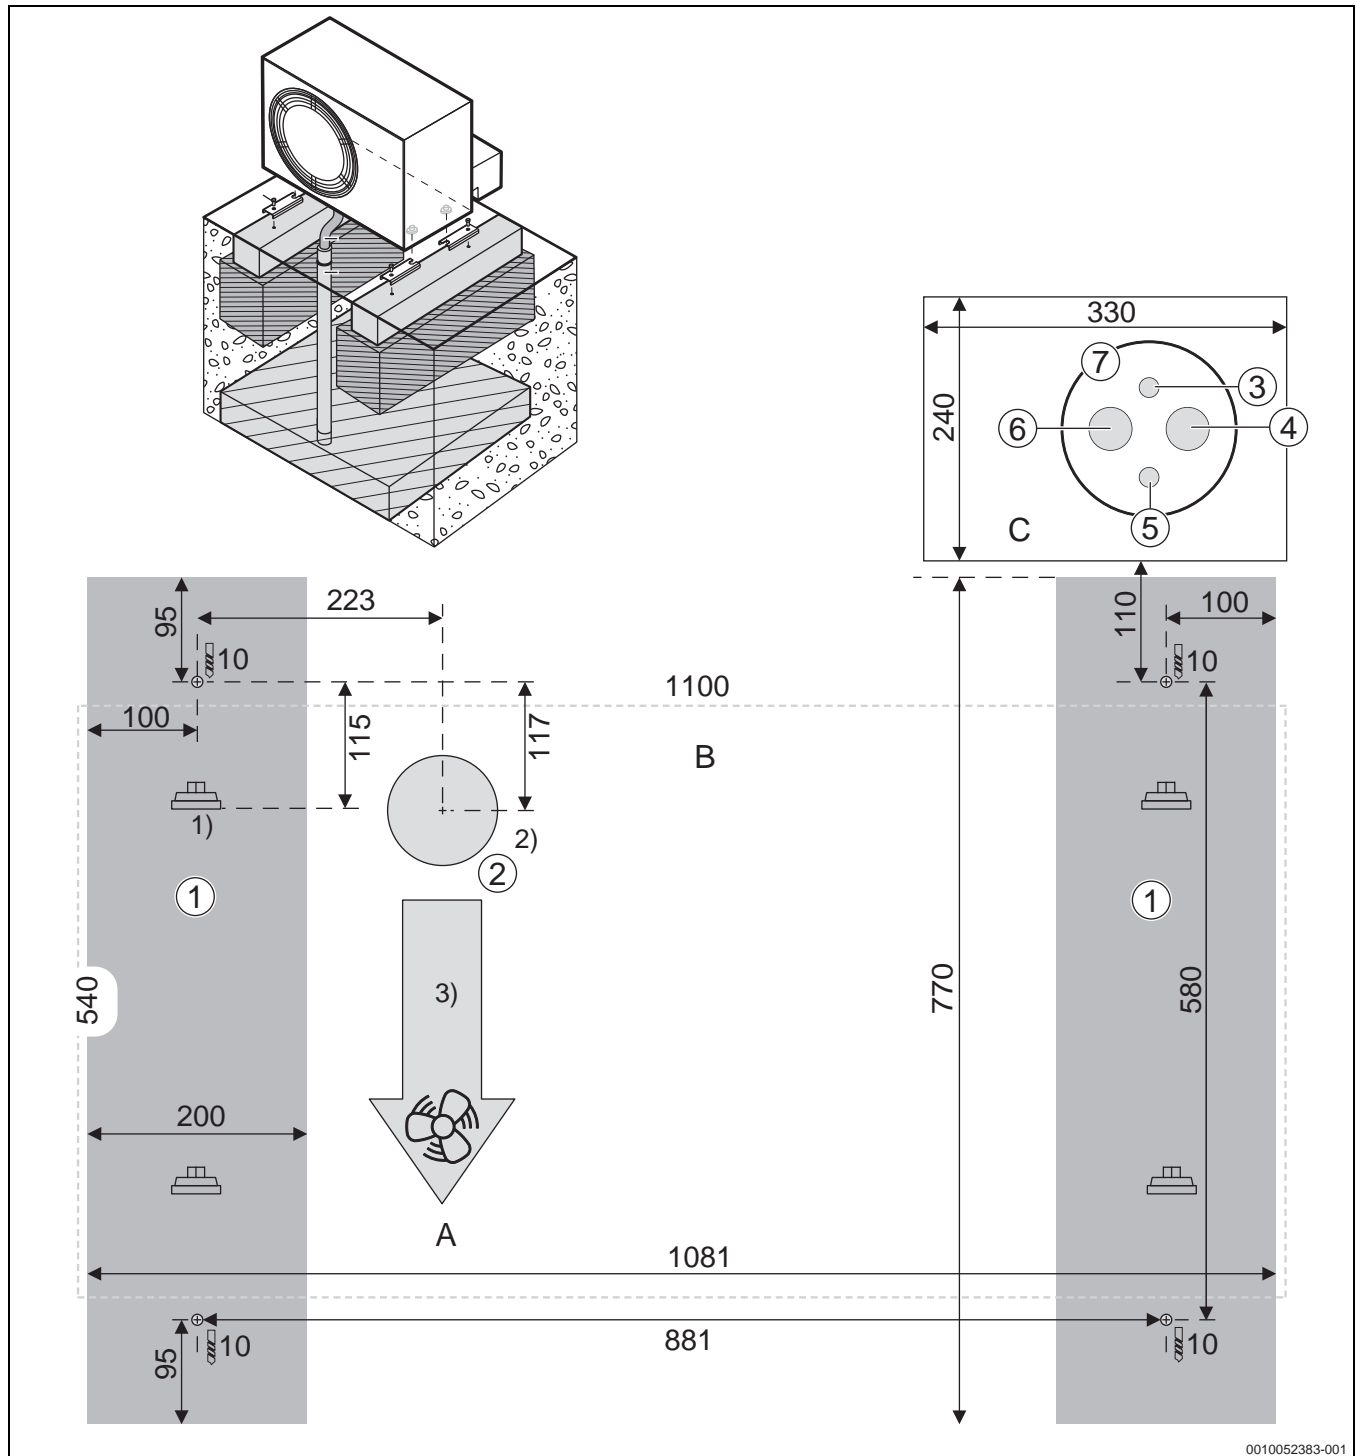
Befestigung der Wärmepumpe mit Montagesockel, Streifenfundament (Maße in mm)
